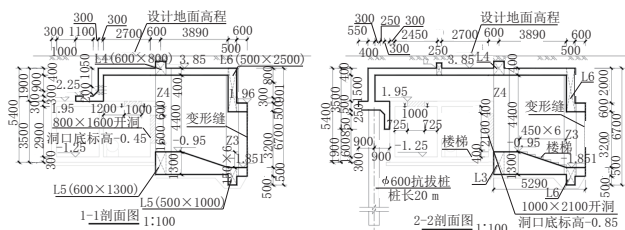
单舱接双舱节点构造(开洞)剖面图(单位:mm)
